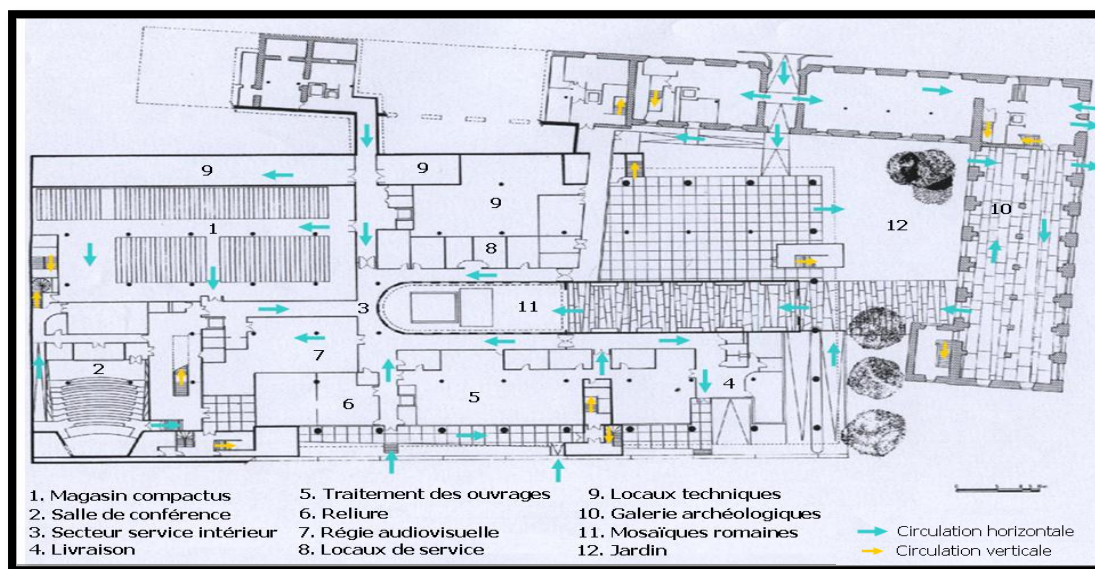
PLAN RDC (Source : Pierre Riboulet)
